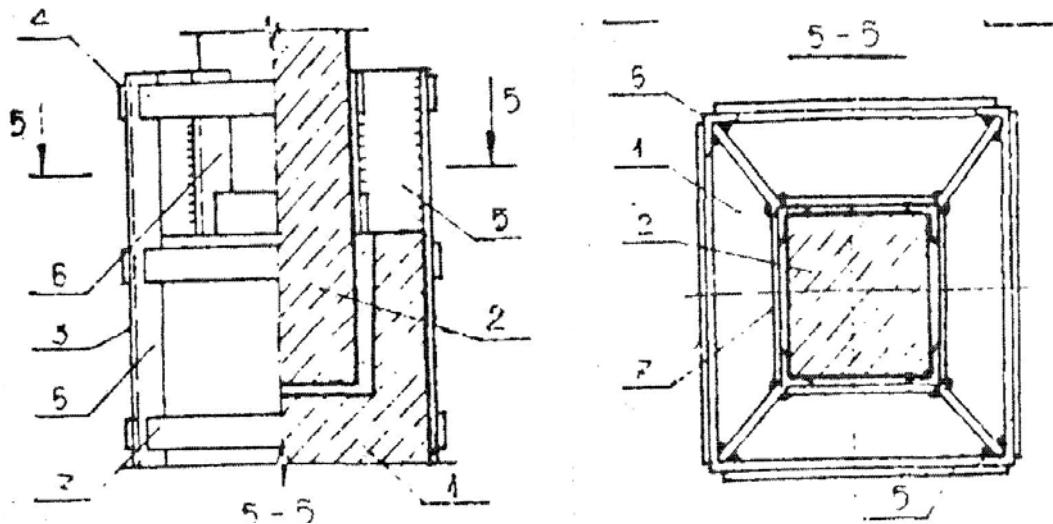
Збільшення опорної площі залізобетонного стовпчастого фундаменту
